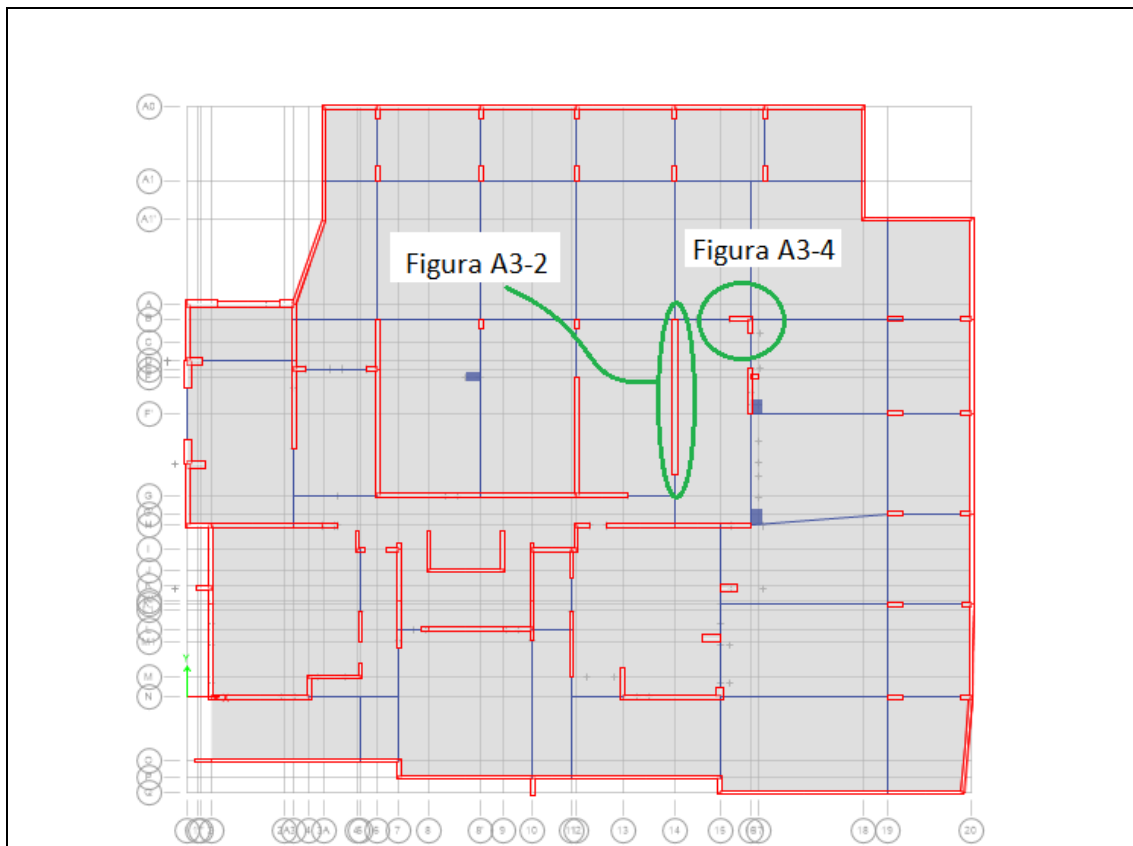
Edificio N1, planta subterráneo 1 indicando elementos dañados
